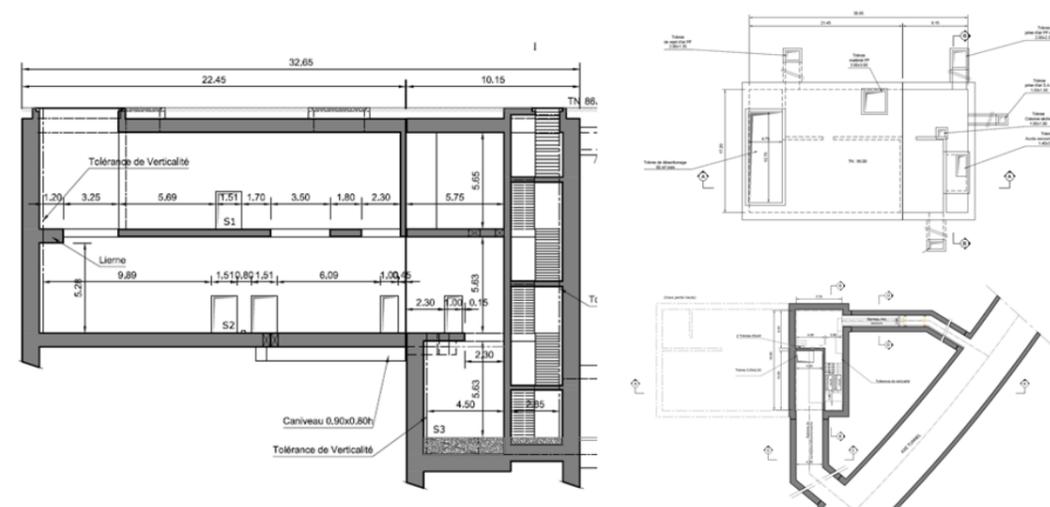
Coupe et vue en plan de l'ouvrage de type B
